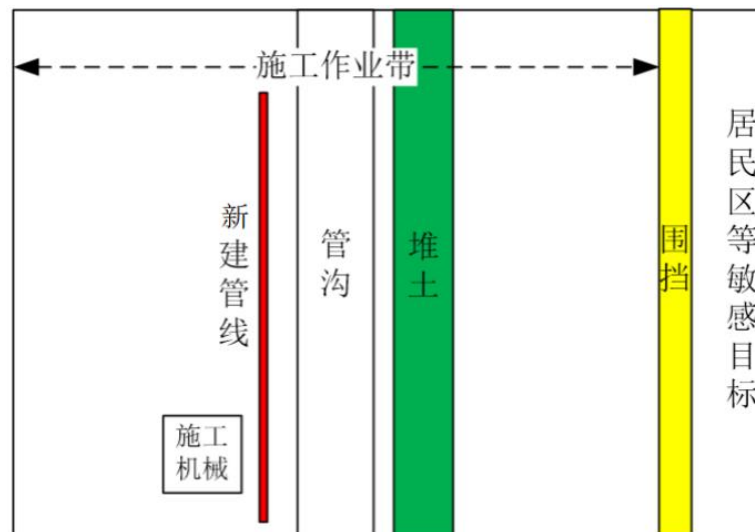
一般开挖段新建管线施工区域平面布局示意图
